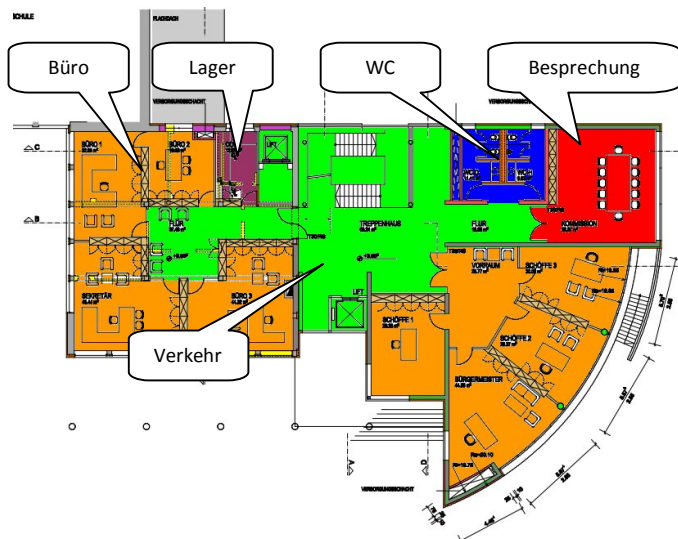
Grundriss Regelgeschoss mit Zonierung, Geb.9
